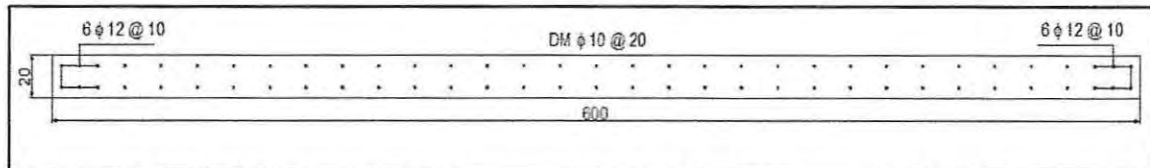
Armadura de flexo-compresión Muro 1, Estructura I (Aislada).
